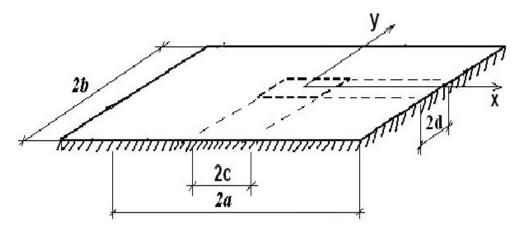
Расчетная схема прямоугольной плиты на упругом основании с отверстием в виде прямоугольника расположенного в центре под плитой
